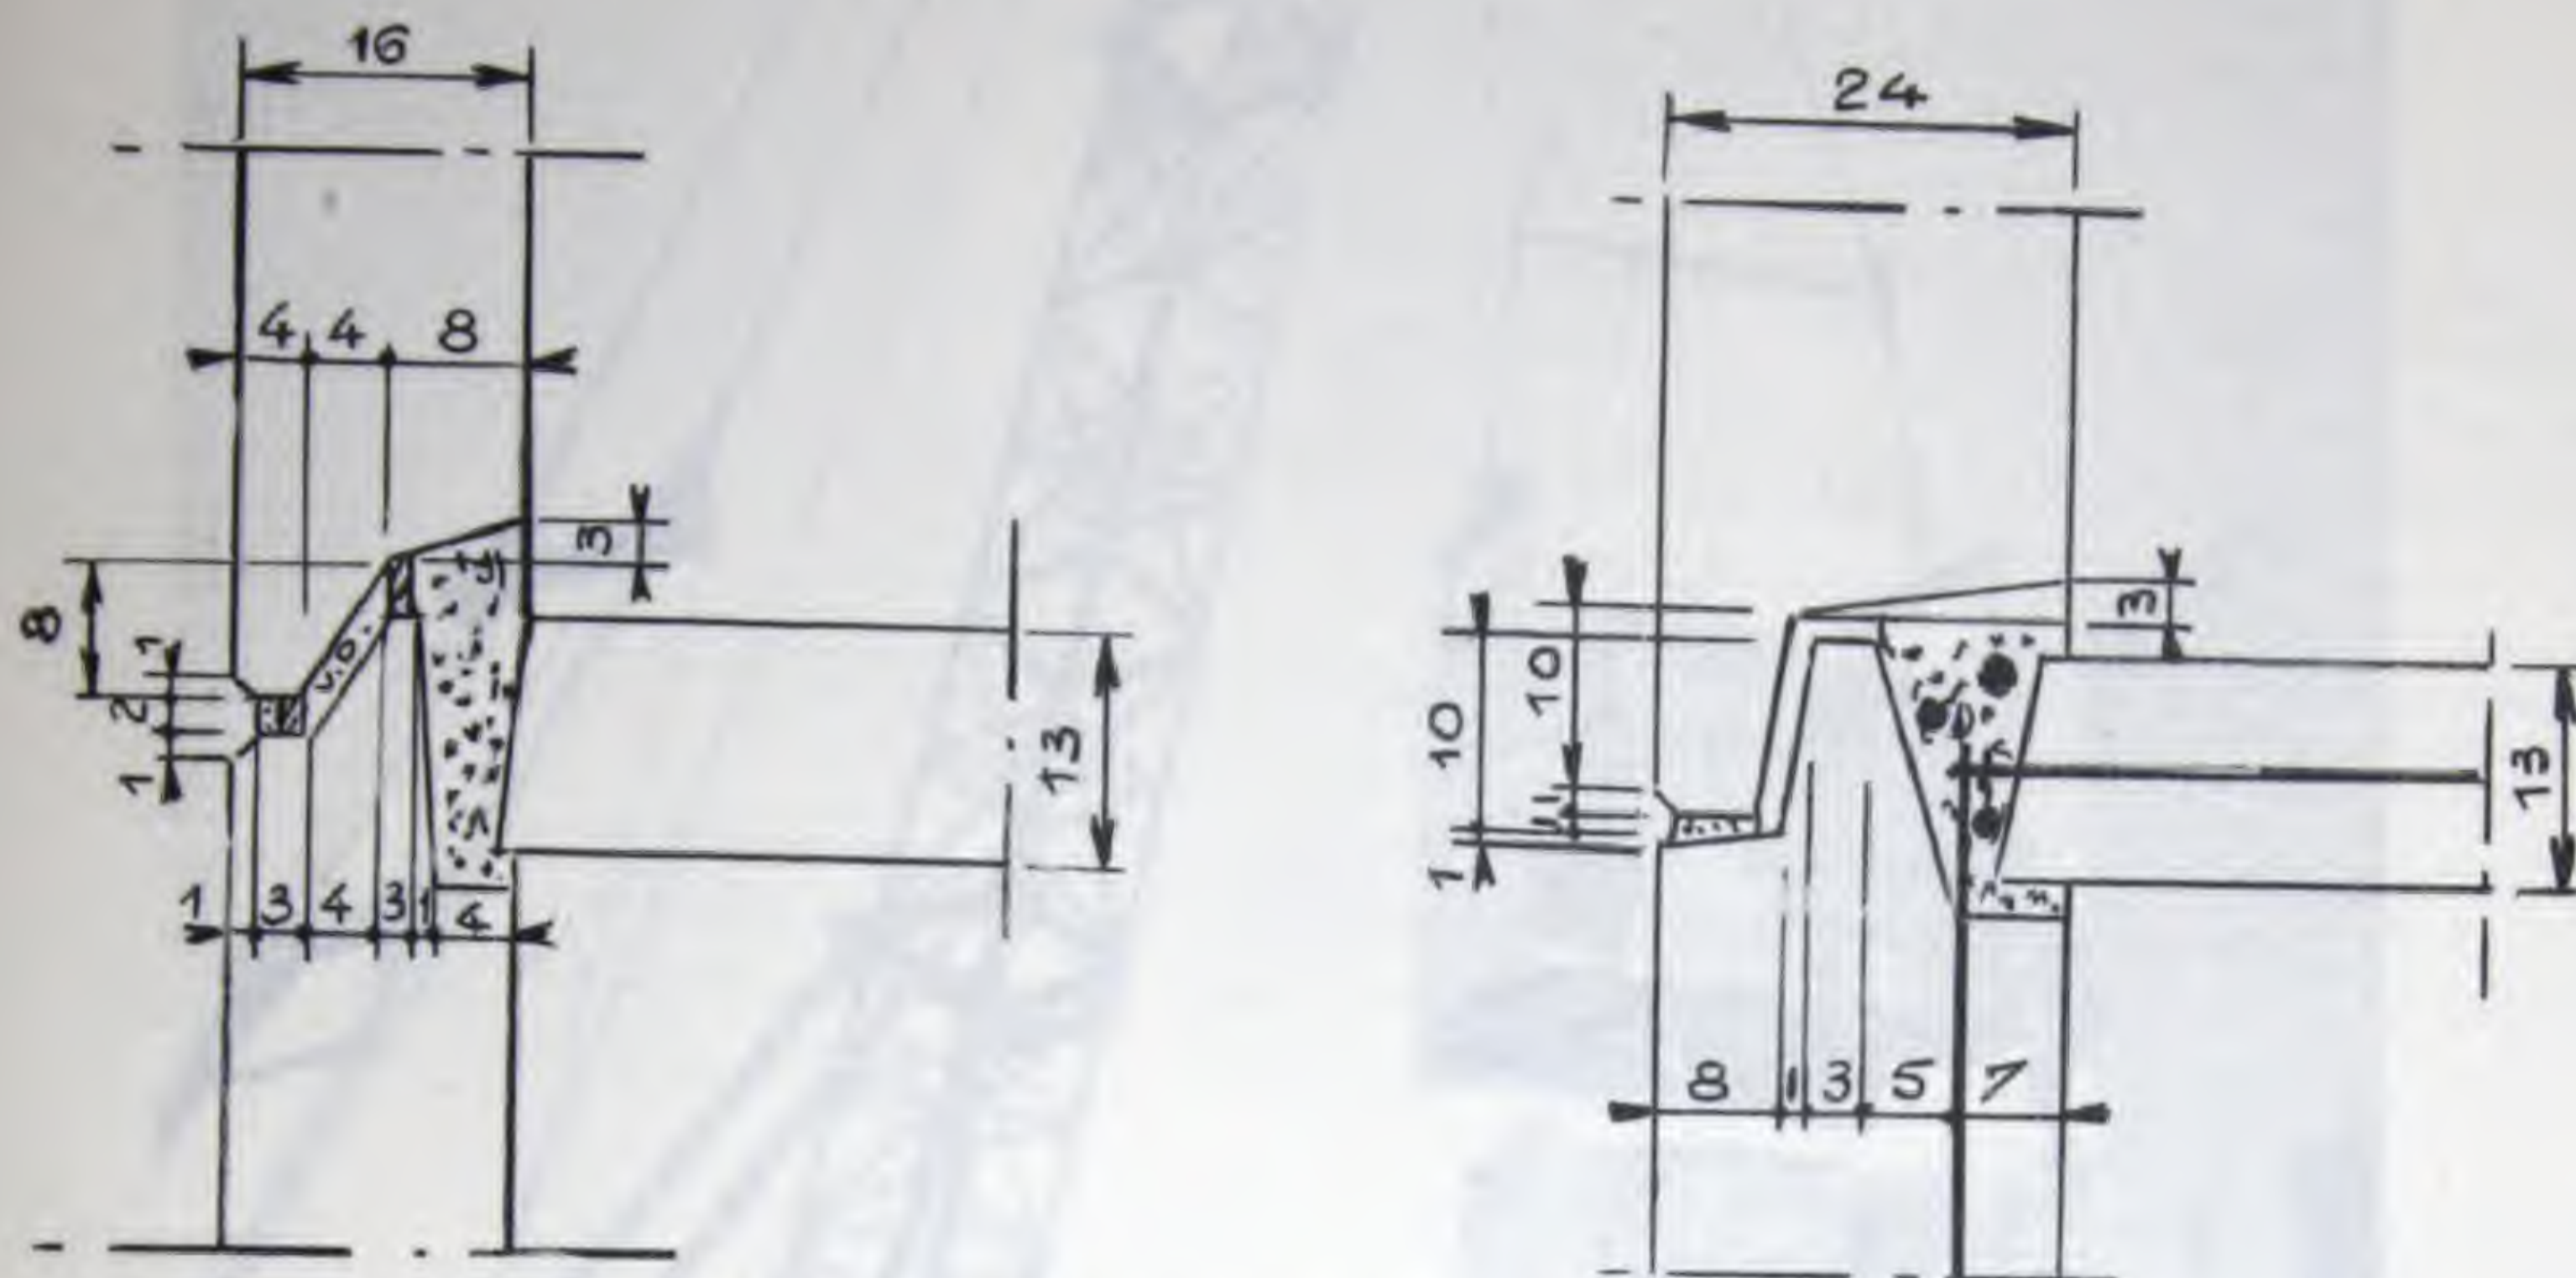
et 29 - Profils de joints et de liaisons horizontaux "mécaniques" : à gauche pour un mur extérieur qui ne porte pas les planchers, à droite pour un mur porteur.
